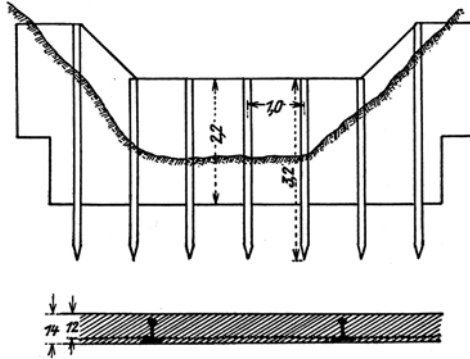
Eisenbetongrundschwelle nach Ing. Angerholzer.
